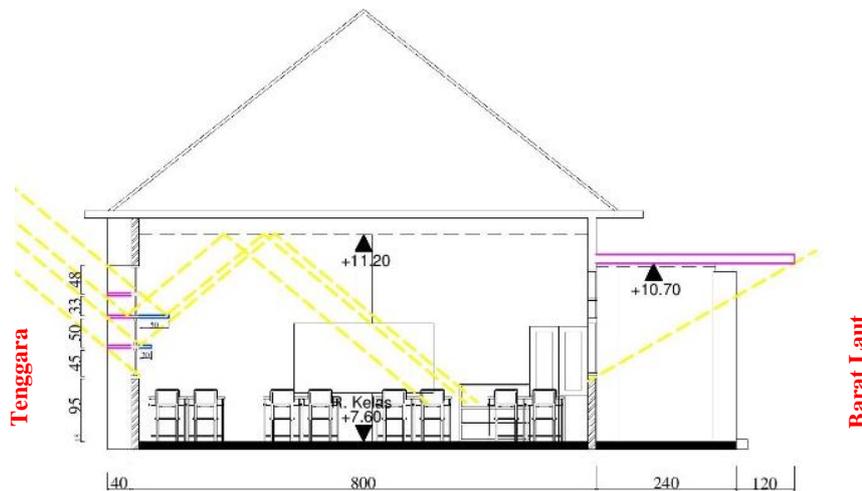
Tampak Tenggara dan Barat Laut Ruang Alternatif 2 Rekomendasi Eksternal-Internal Ruang Kelas IPA
